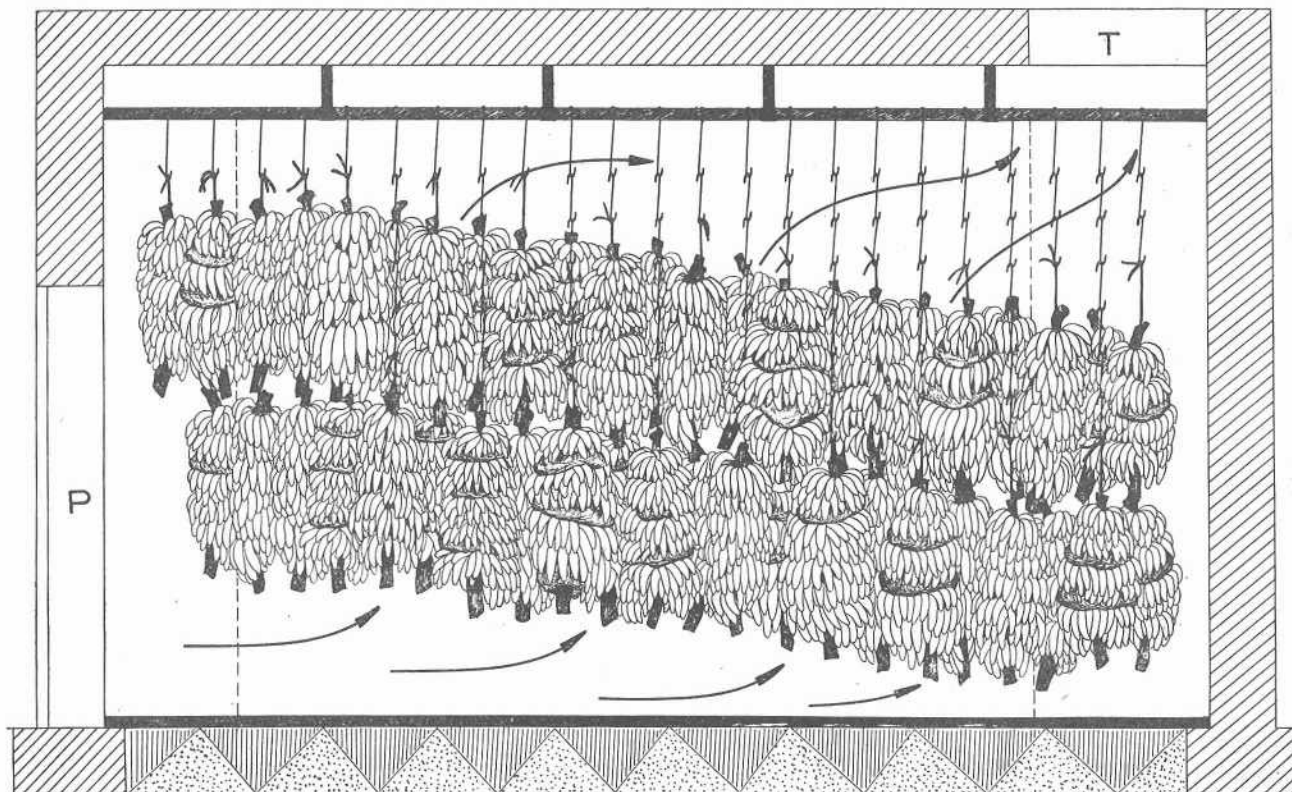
Coupe verticale de la chambre quand la trappe est située en face de la porte.
